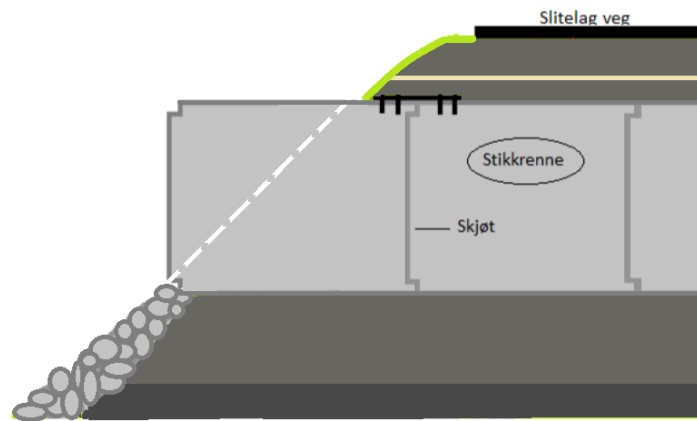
Stikkrenne av betong som er blitt utsatt for setningsskader
